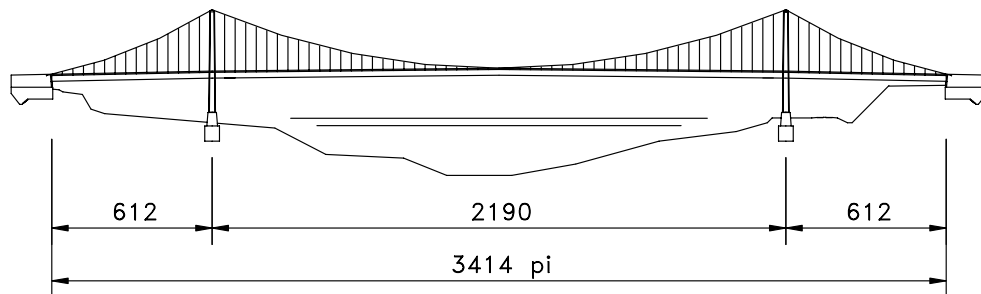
Pont Pierre-Laporte sur le fleuve Saint-Laurent
